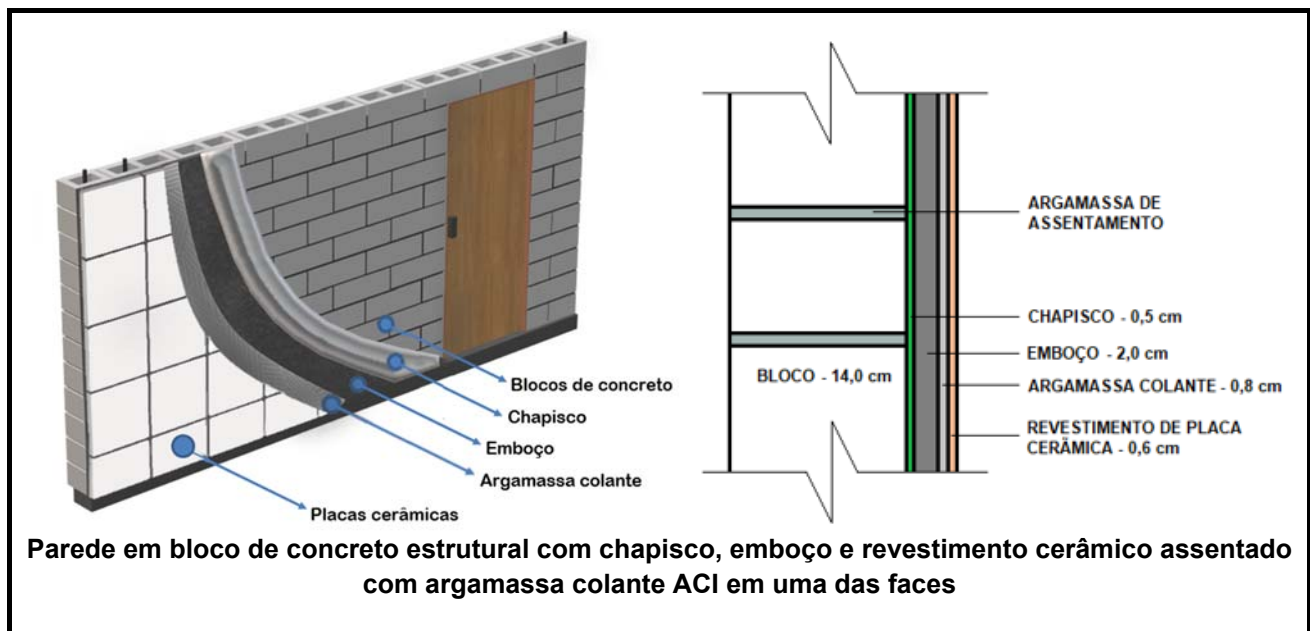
Croqui e seção transversal do elemento construtivo objeto desta FAD
